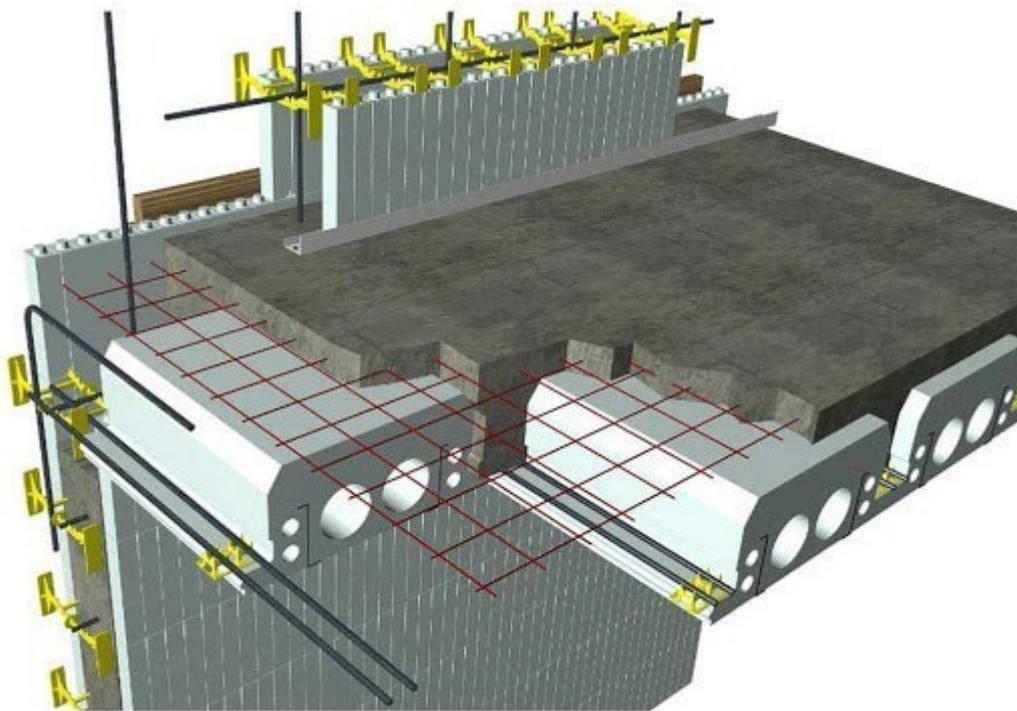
Ancoraggio parete-solaio di dettaglio e di posa in cantiere e delle varie stratigrafie dei blocchi ICF. 2017, SSDHQ
